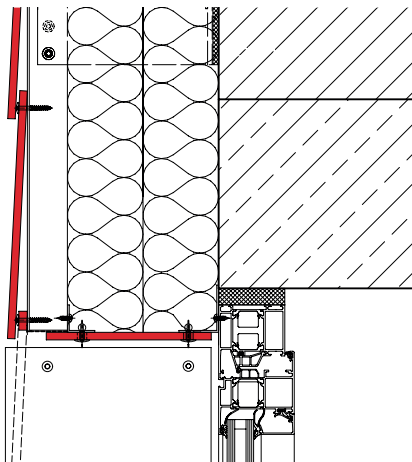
DETAILS STÜLPSCHALUNG MIT SCHRAUBE
